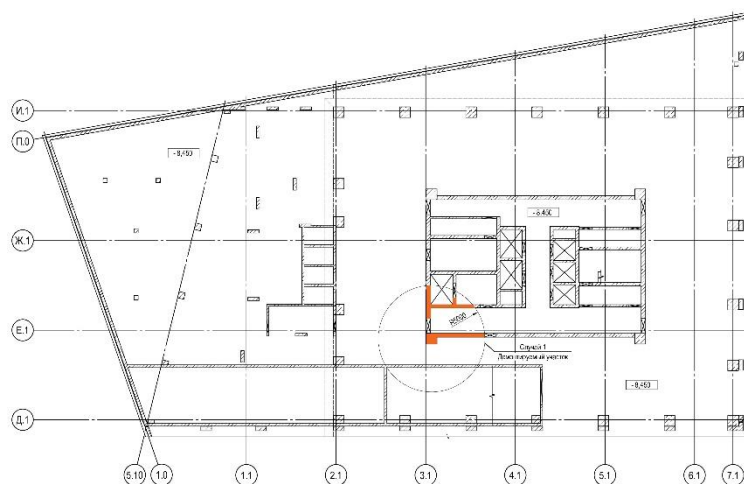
Корпус К-1. Схема аварийного случая 1
